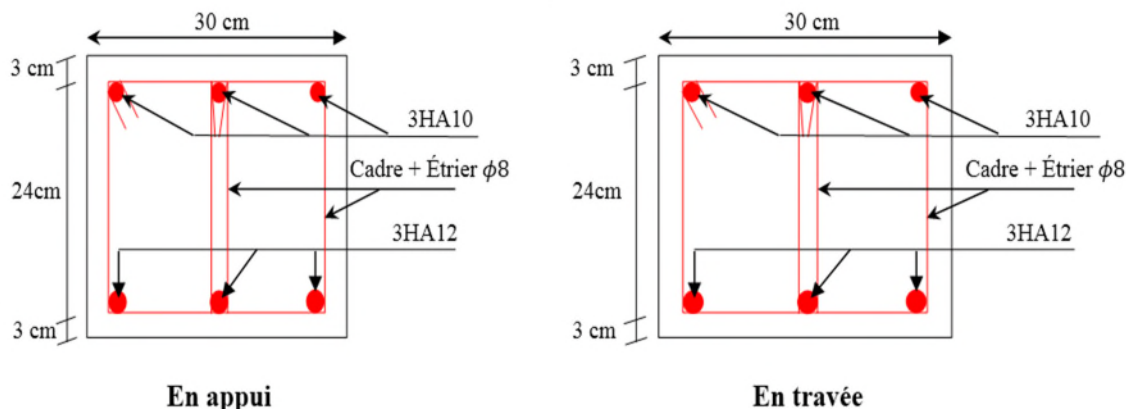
Schéma de ferrailage de la poutre de chaînage.
